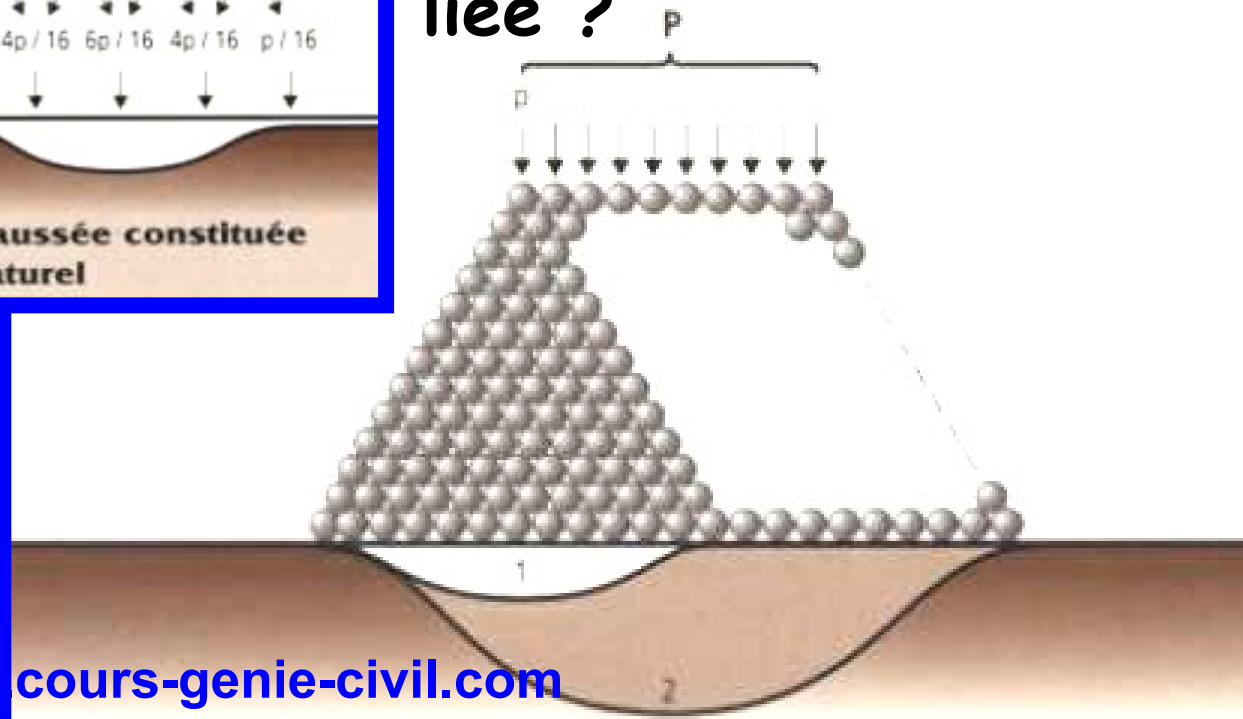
Schéma de fonctionnement d'une chaussée constituée d'une couche non liée reposant sur le sol naturel
